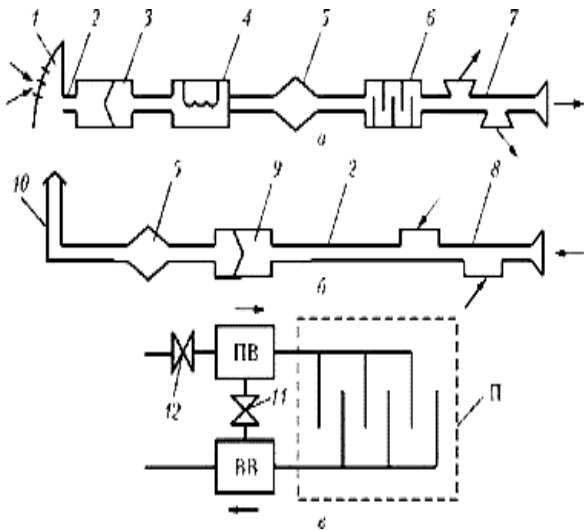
Схемы общеобменной механической вентиляции: а – приточная вентиляция (ПВ); б – вытяжная вентиляция (ВВ); в – приточно-вытяжная вентиляция с рециркуляцией;
